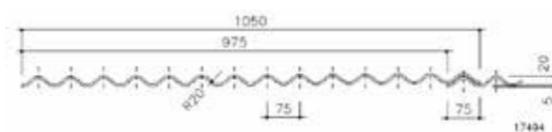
Plaque ondulée ARDEX profil 75/20 - coupe
